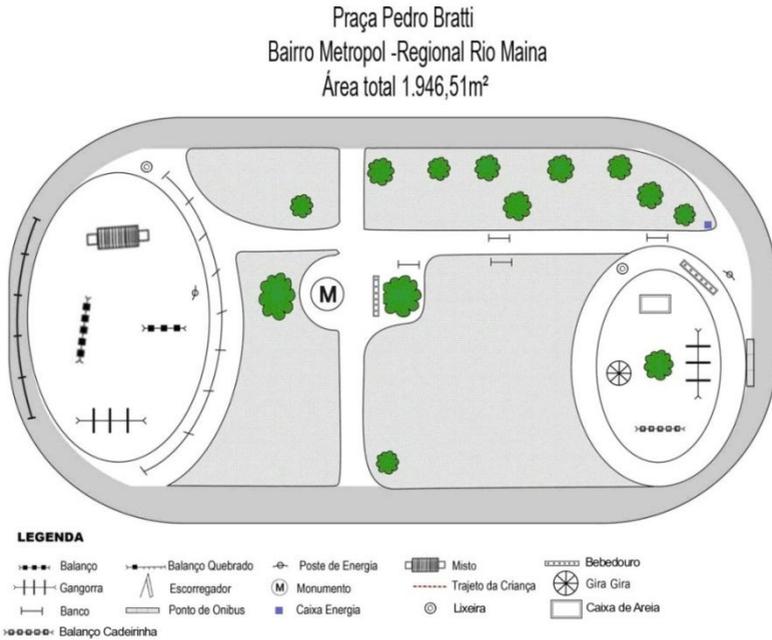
Planta baixa da praça modificada a partir do projeto 2.
